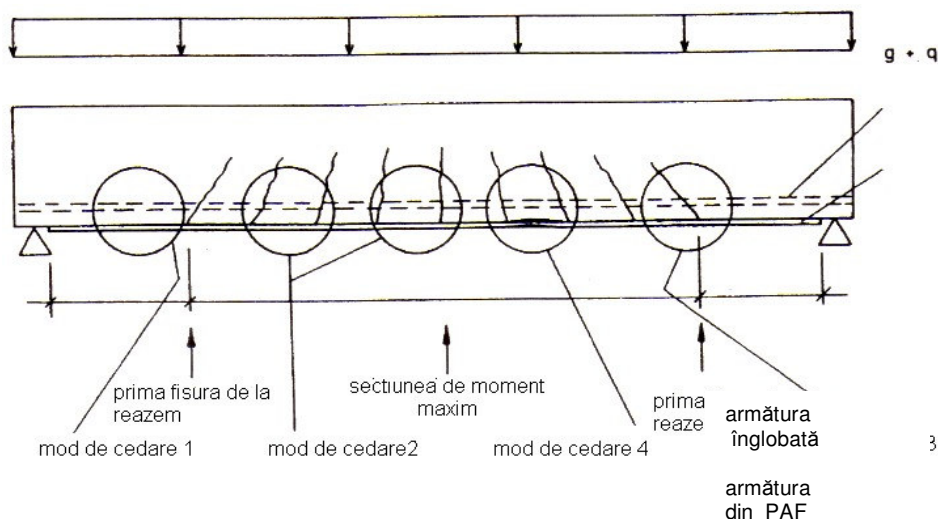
Moduri de cedare a unui element de beton consolidat cu armătură tip PAF
